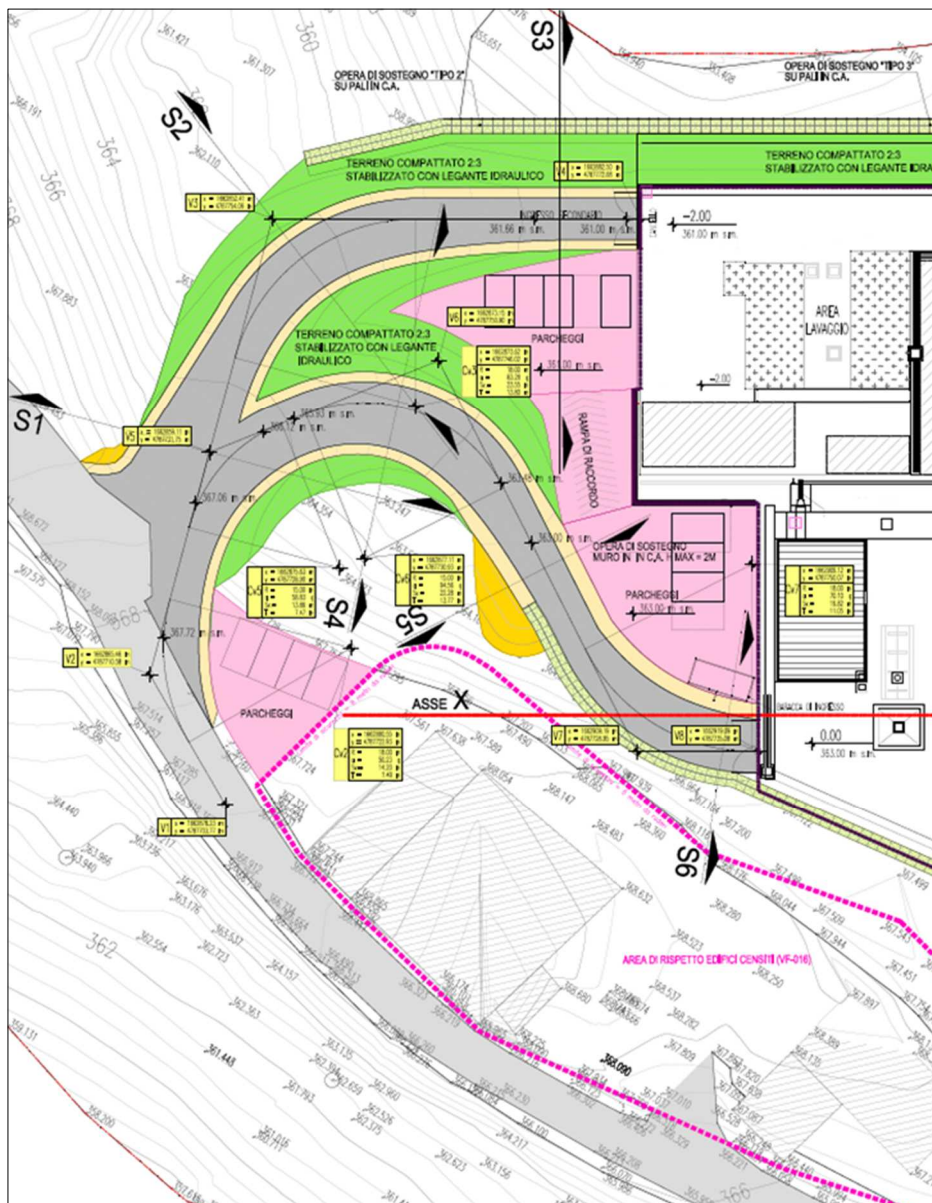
Planimetria delle bretelle di accesso e aree parcheggio (in colore rosa).
